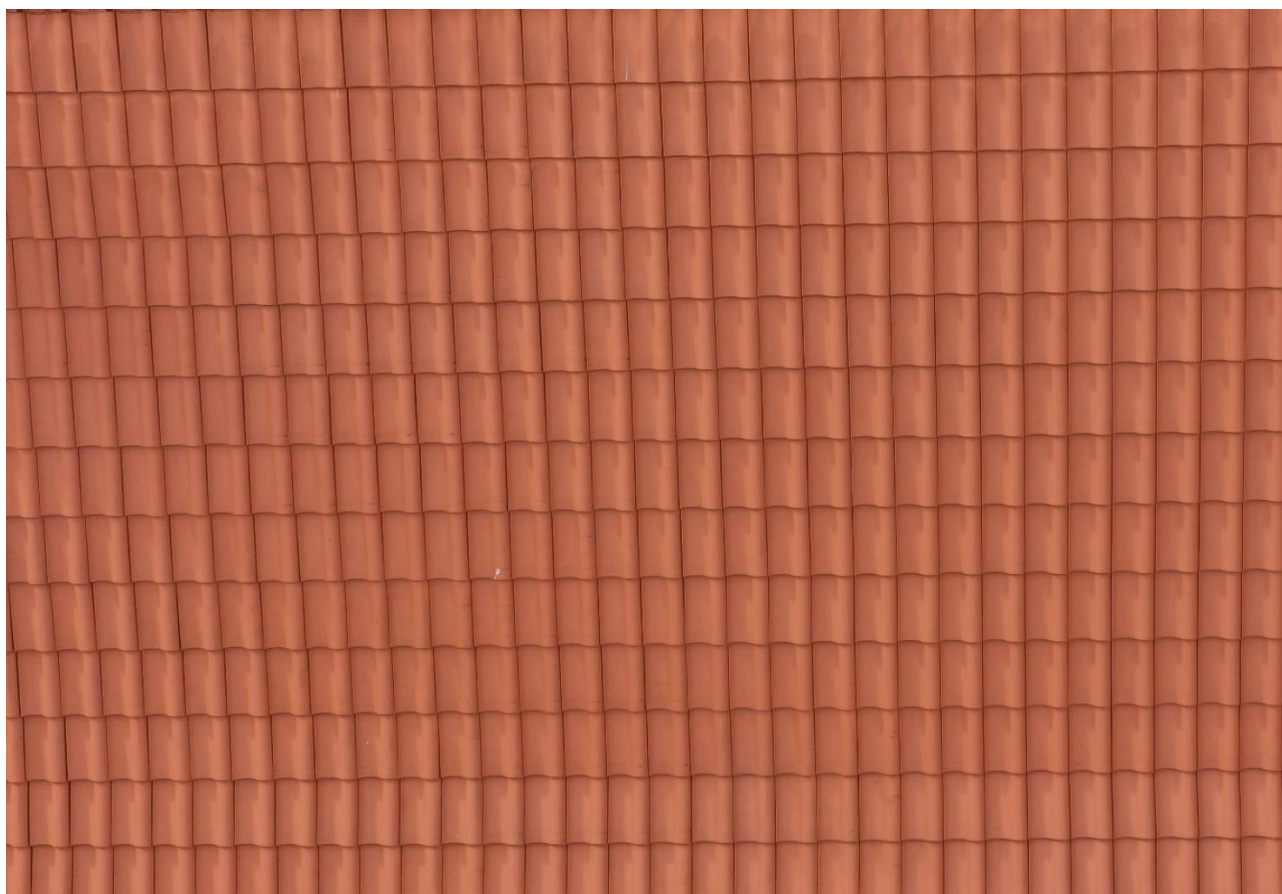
Połąć wschodnia skrzydła zachodniego.
